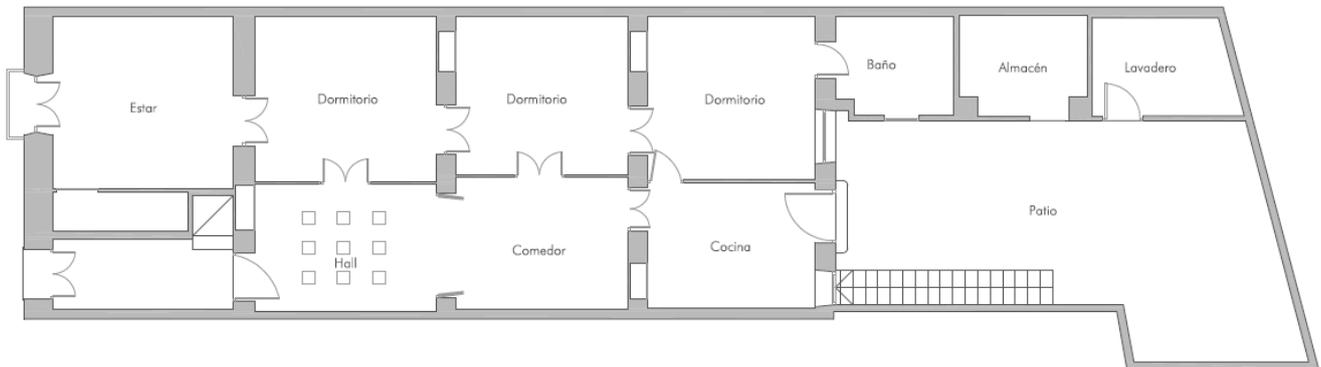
Plano distribución vivienda previa a la reforma. Fuente: Proyecto Básico Ejecución de la vivienda de José Manuel Mena Toledo (Arquitecto)
